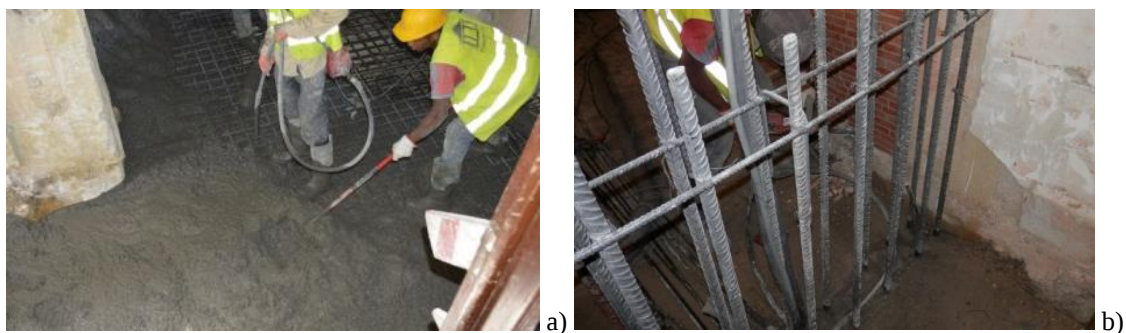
Laje de ensoleiramento: a) betonagem; b) localização das armaduras de arranque das novas paredes de betão estrutural
